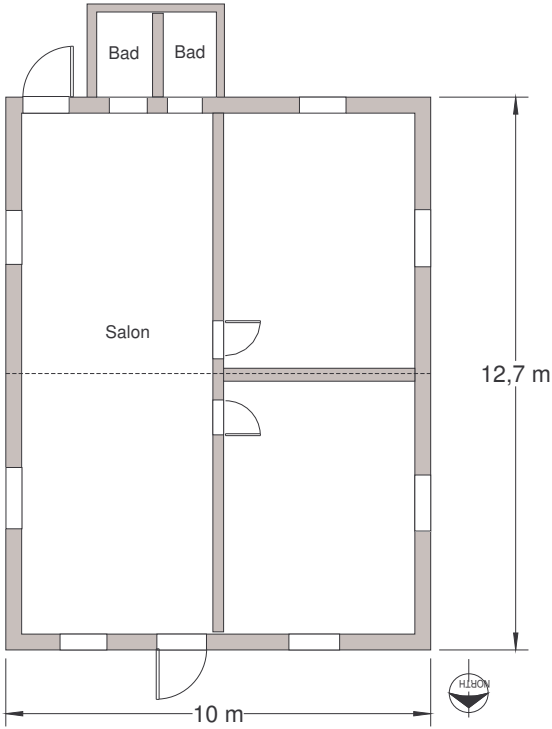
Grundriss des Kindergartens in Cienaga
